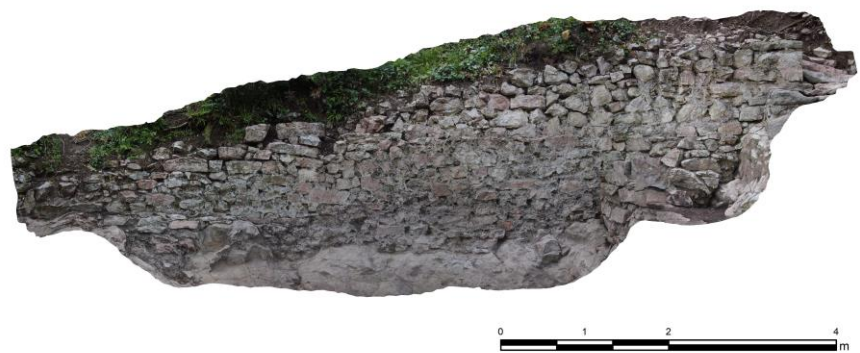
Prospetto della struttura di terrazzamento 2003.
